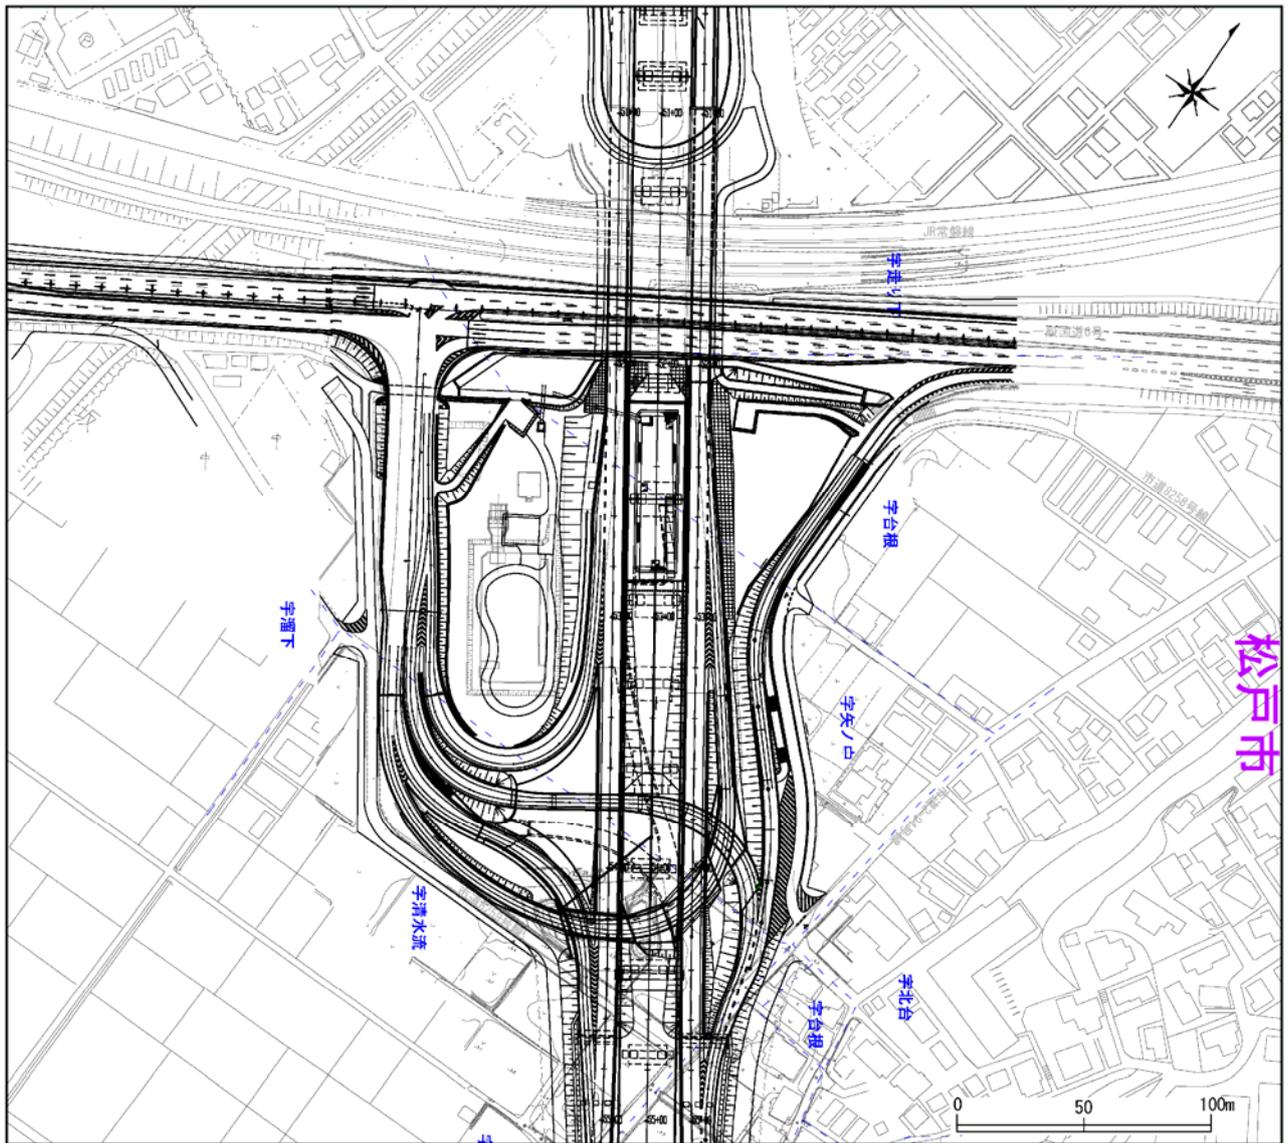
(13) 特殊部予測平面図 (矢切交差部)
